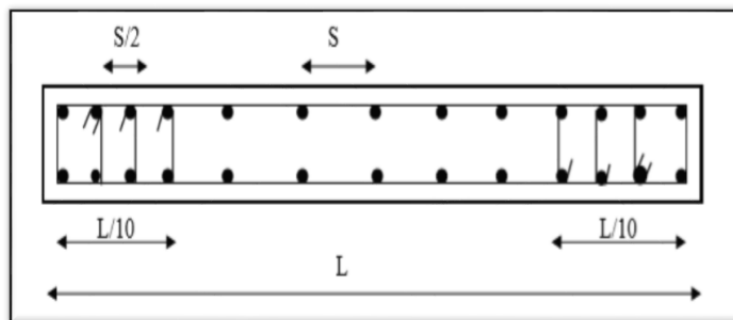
Disposition des armatures verticales (vue en plan)
